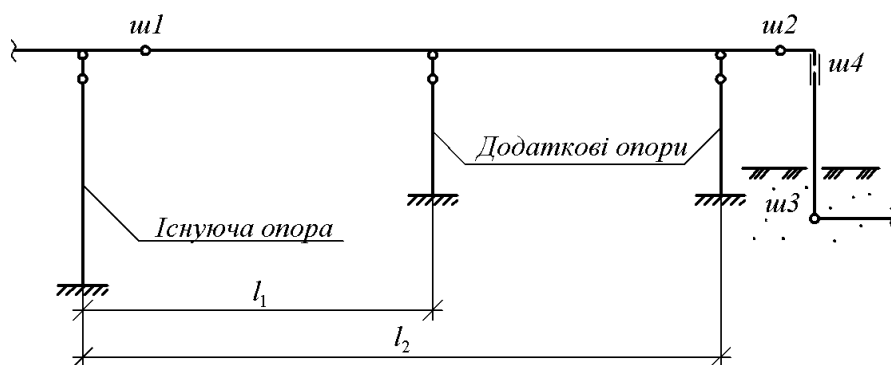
Фрагмент розрахункової схеми № 2 надземного переходу трубопроводу.
